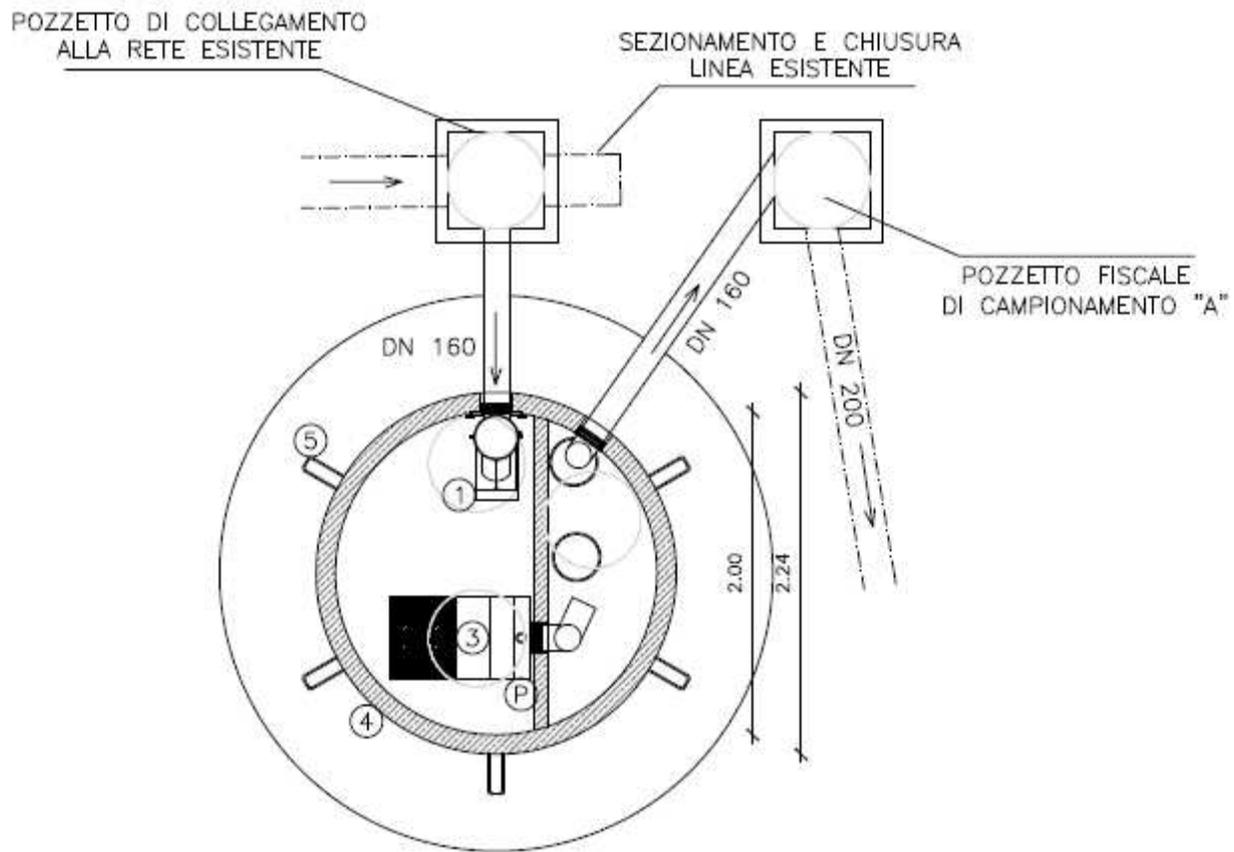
Pianta dell'impianto di trattamento delle acque reflue di raffreddamento.
